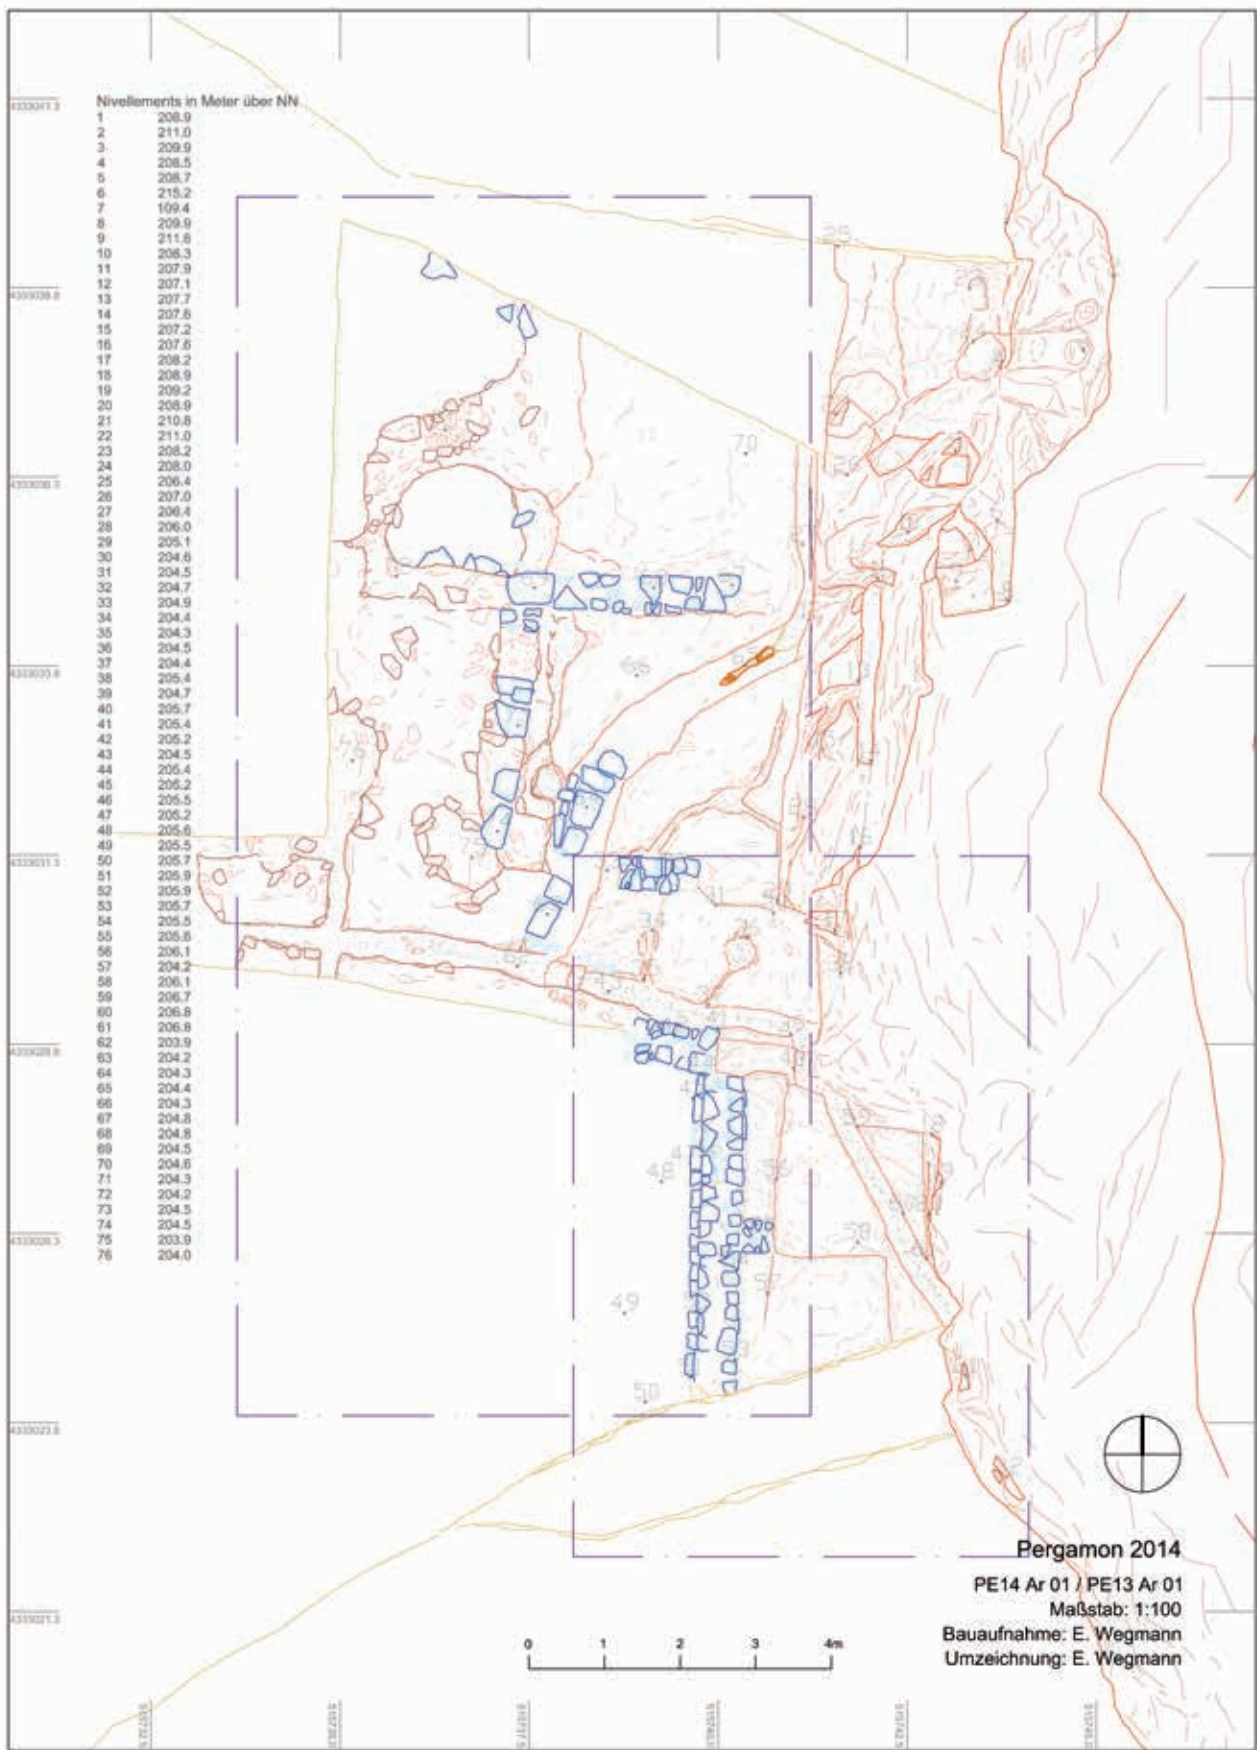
Pergamon, Stadtberg Westhang, Areal 1 (mutmaßliches Felsheiligtum 4). Plan (M. 1 : 100)
